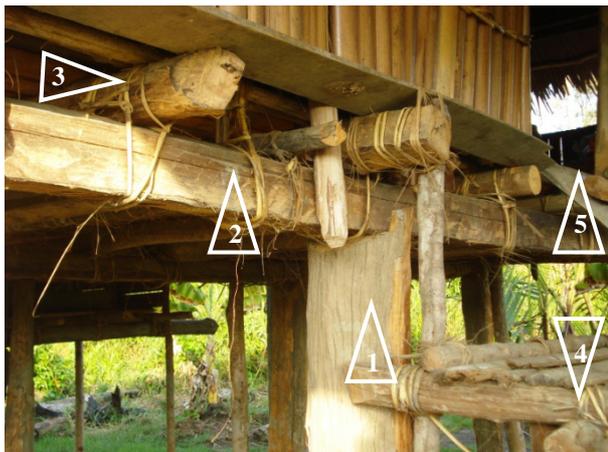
Detail (1): Anbindung Stütze zu Fußbodenkonstruktion (Quelle: privat, 15.12.2015)
